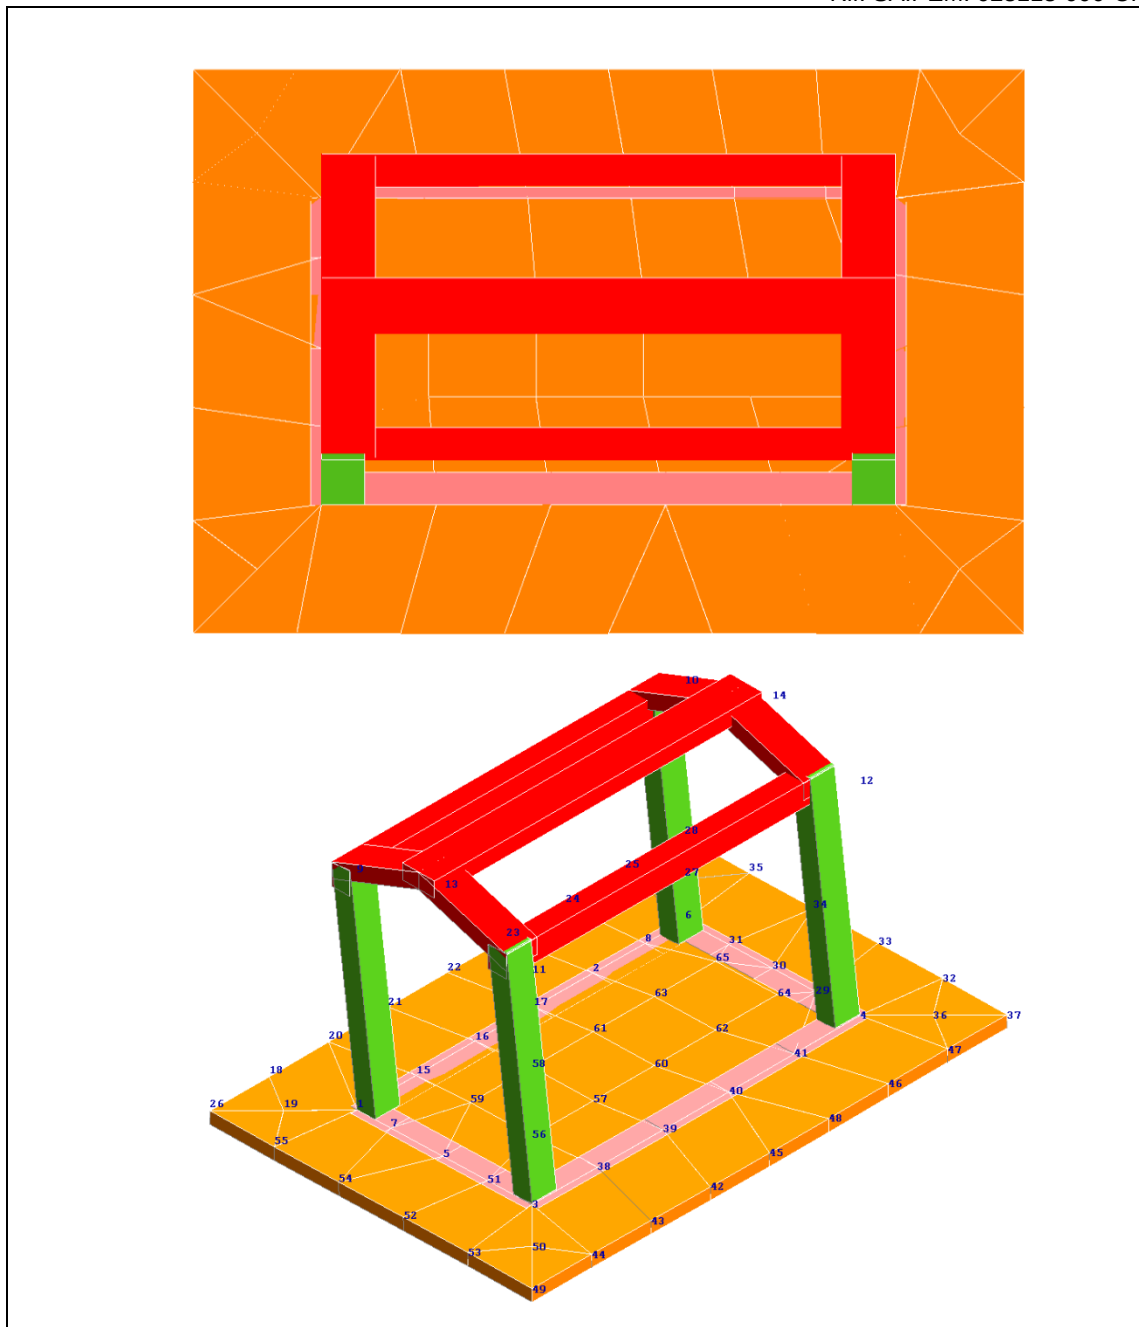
Modo 1 - Traslazione in direzione Y (vista in pianta e assonometria)
